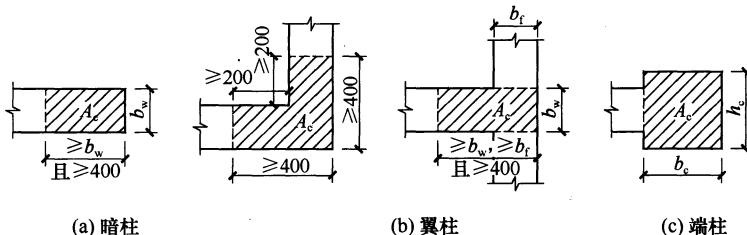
钢筋混凝土抗震墙的构造边缘构件范围
